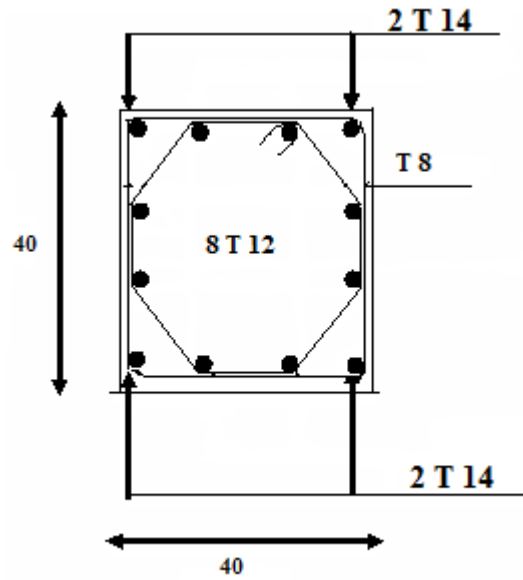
coupe de ferrailage des poteaux 40x40 cm²
